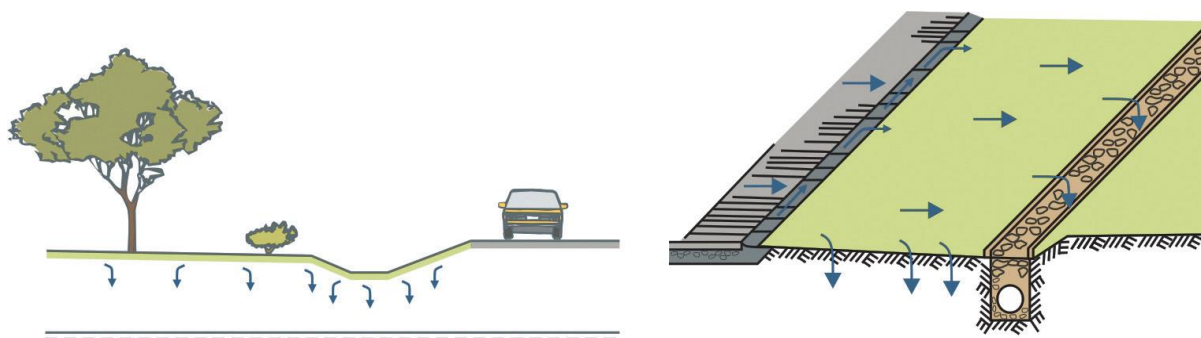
Esquema de vala (a) e plano (b) de infiltração
